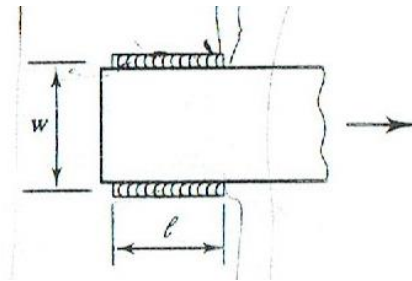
Miembro conectado a través de soldadura.
